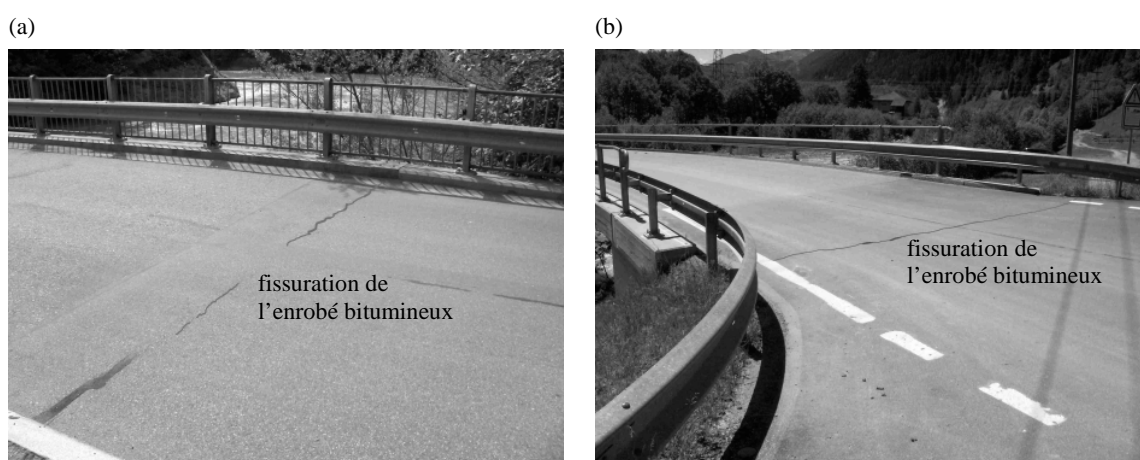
Exemples de fissuration de la surface de roulement au niveau du détail de connexion entre la culée et la dalle de transition [Kaufmann 2009], détails de connexion selon la figure 2.14 (a); (a) Pont semi-intégral de 68 m de longueur construit en 1986 à Reichenau/CH; (b) Pont semi-intégral de 80 m de longueur construit en 2000 à Cumpadials/CH
